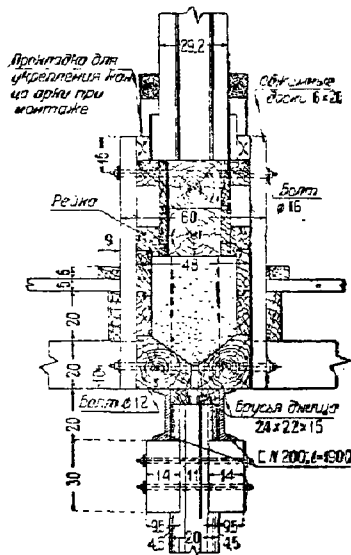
Леса для сборки ребристого свода-оболочки; продольный разрез
